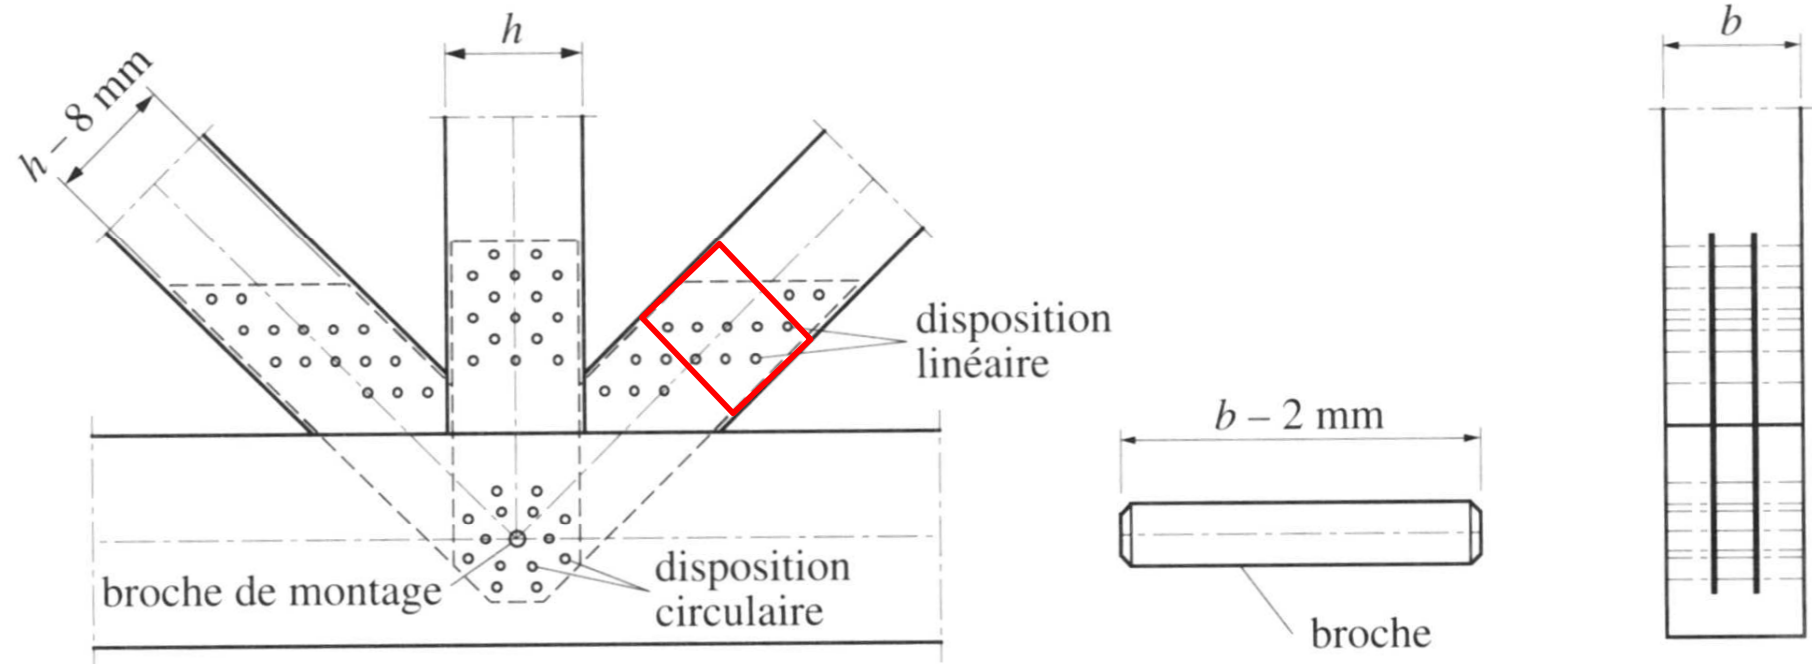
Assemblage d'une poutre triangulée avec le système BSB.
